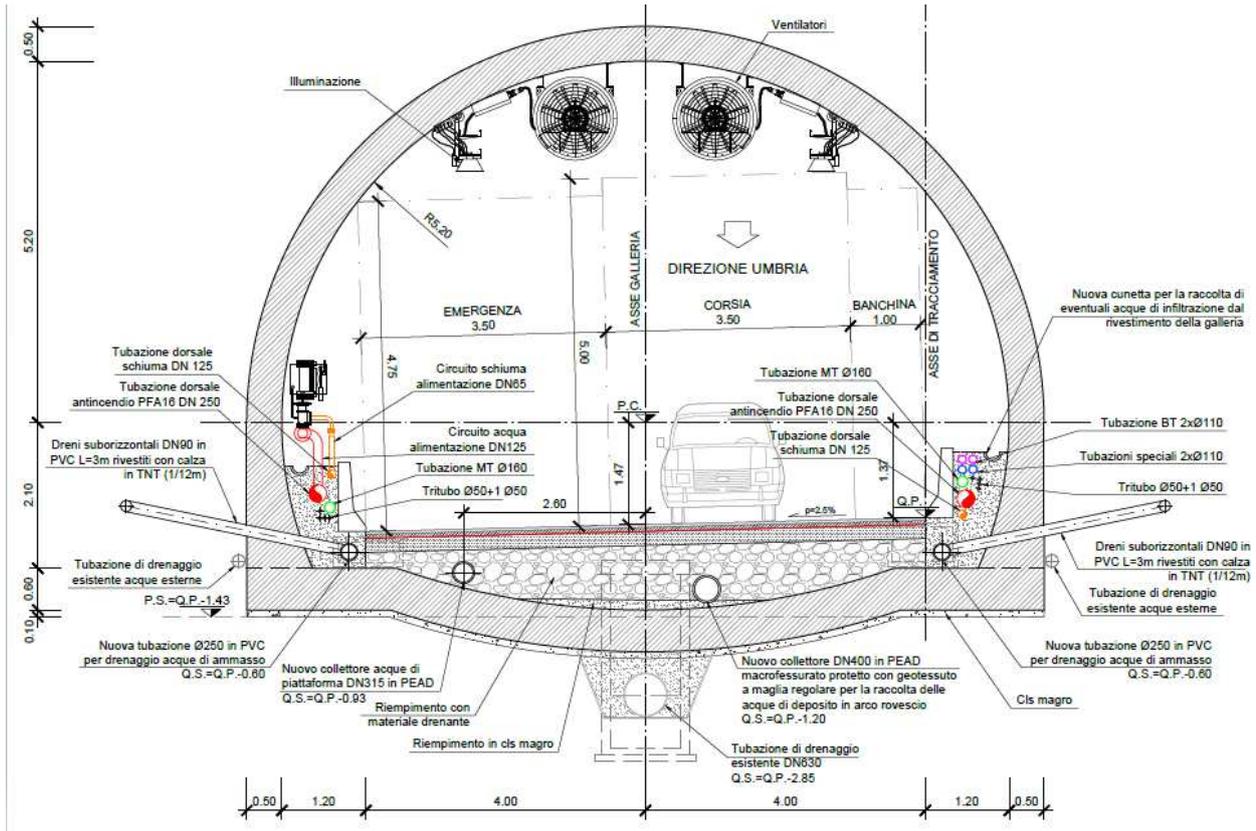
Galleria Guinza - Sistemazione idraulica – Sezione corrente
